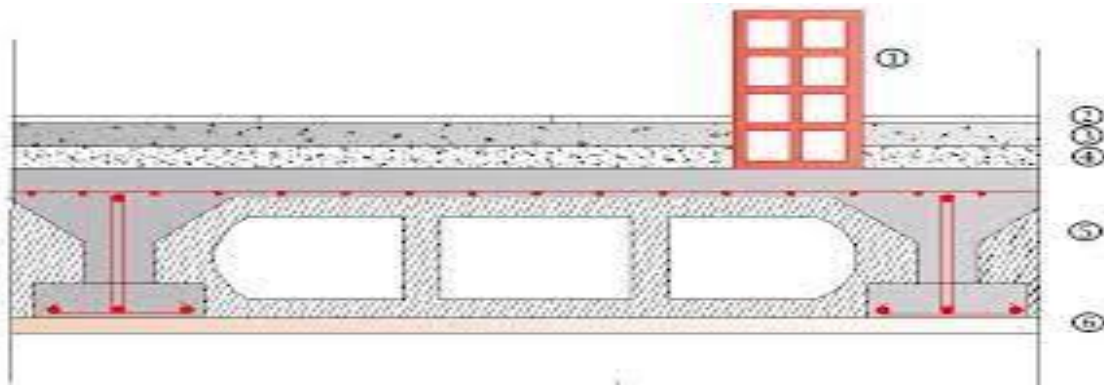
Coupe d'un plancher d'étage courant en corps creux.
